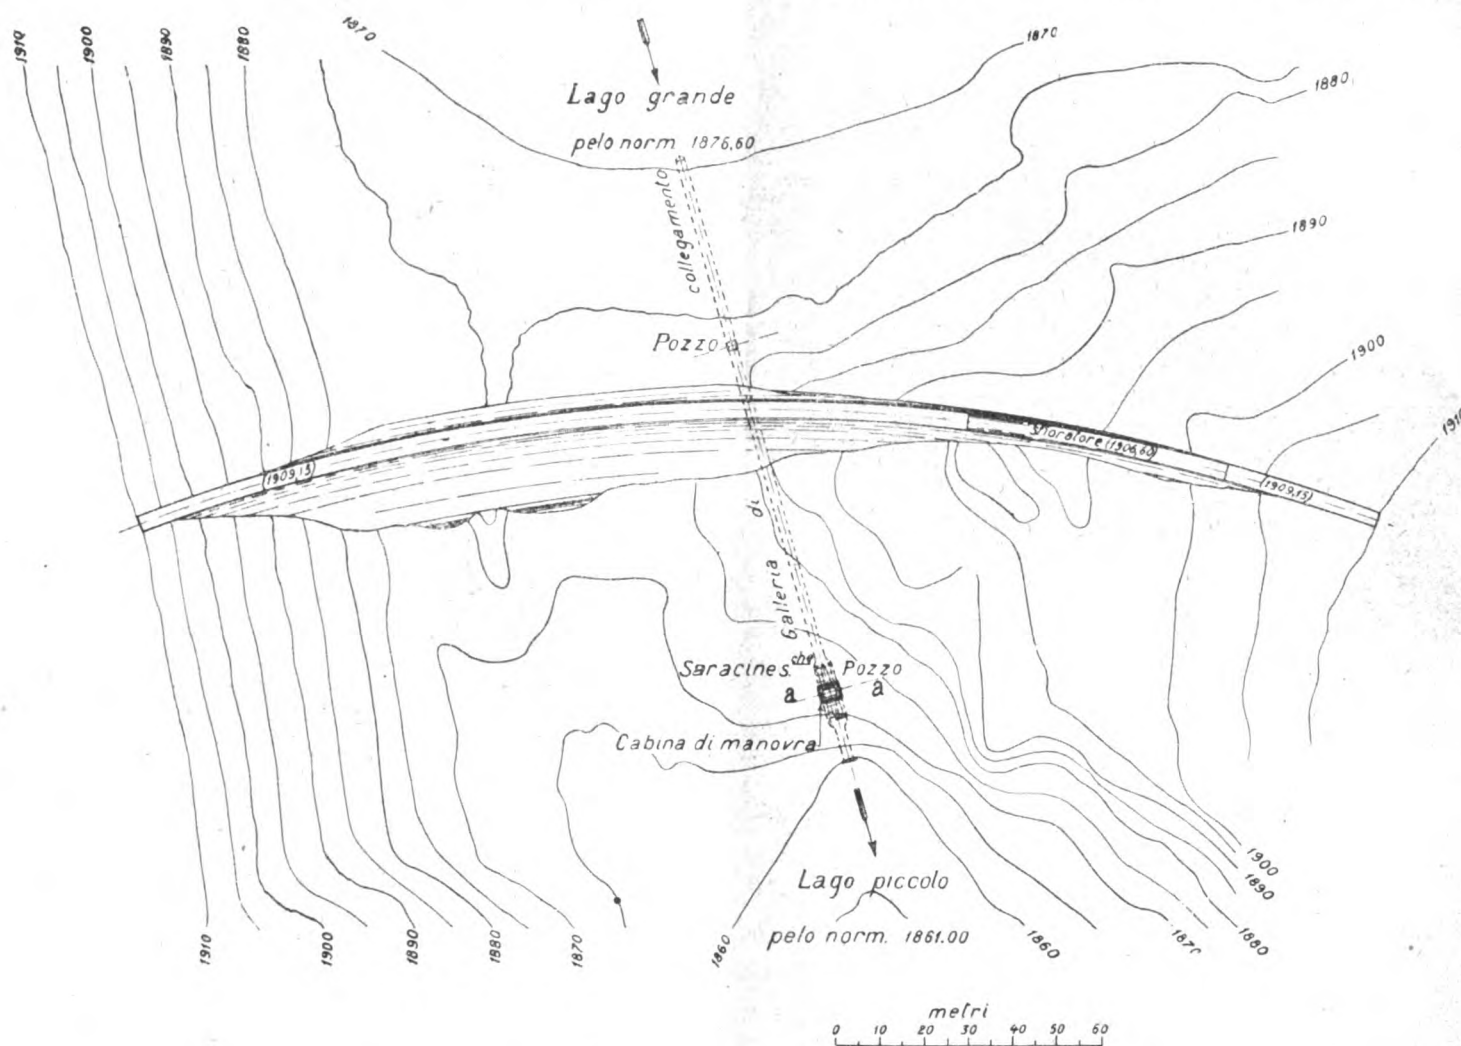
Planimetria dello sbarramento del lago grande d'Avio.
